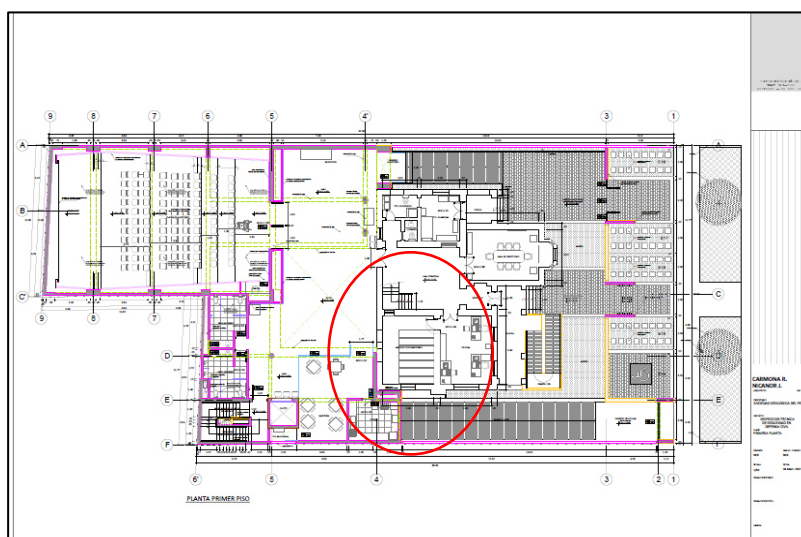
Imagen de plano de la 1º Planta de la SGP – resaltando la biblioteca con rojo. Fuente: SGP
